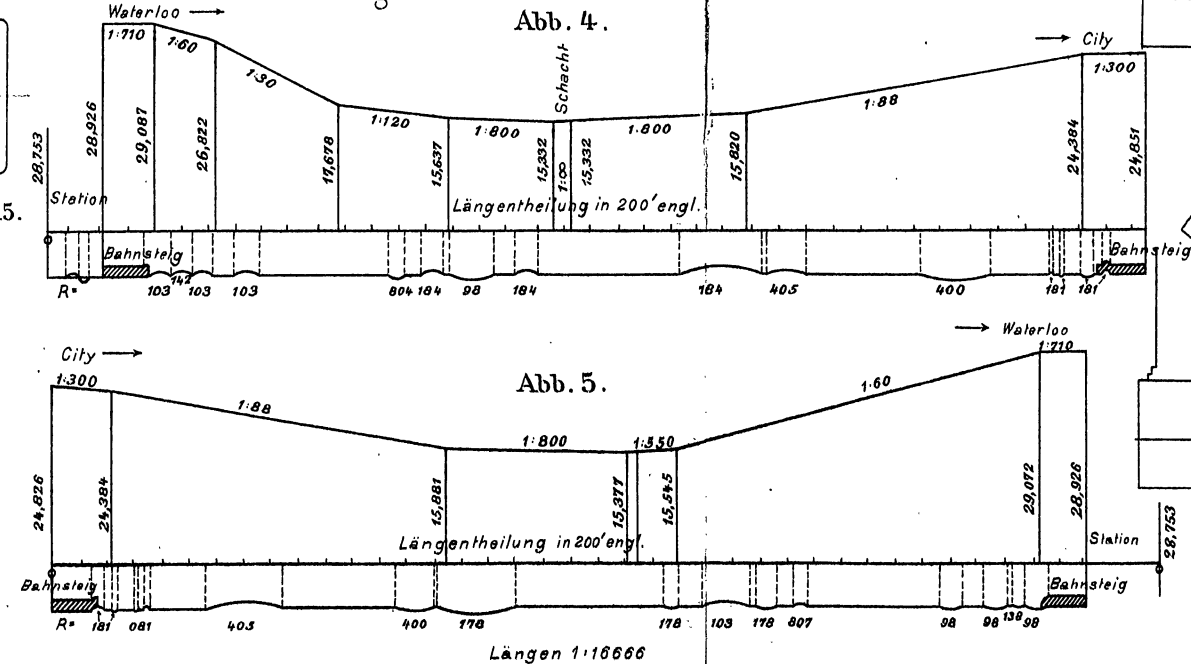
Waterloo-und City-Untergrundbahn in London.
